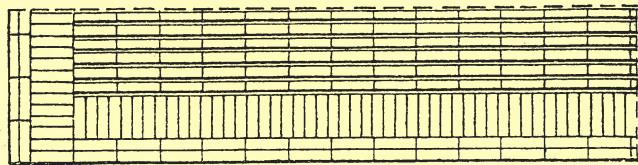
Feldbrand oder Meiler. Grundrisse.
